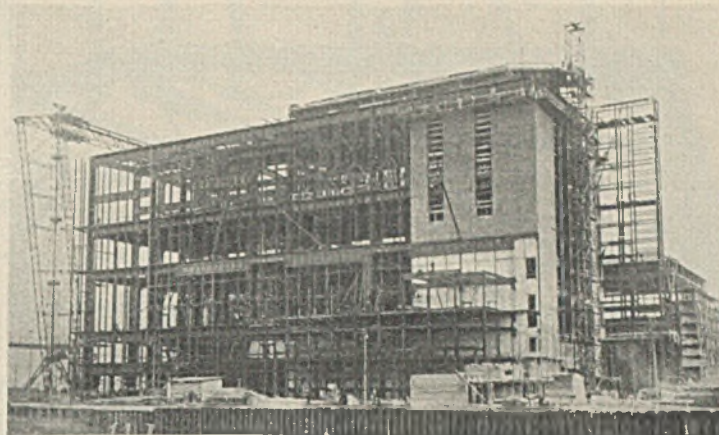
Kesselhausmontage beendet; Dach und Umfassungsmauern im Bau. 19. November 1929.
